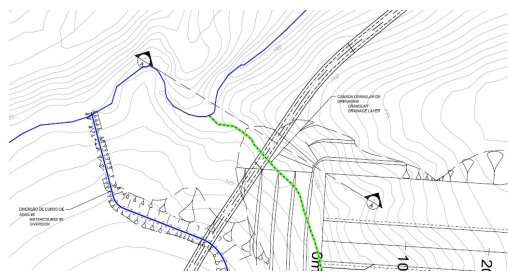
Projeção da saia do aterro invadindo acesso local, planta inicial do empreendimento
